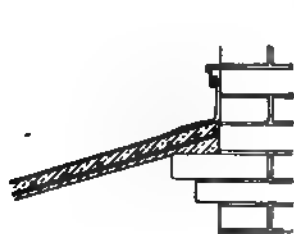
Anschluß der Dachplatte an eine massive Wand.
